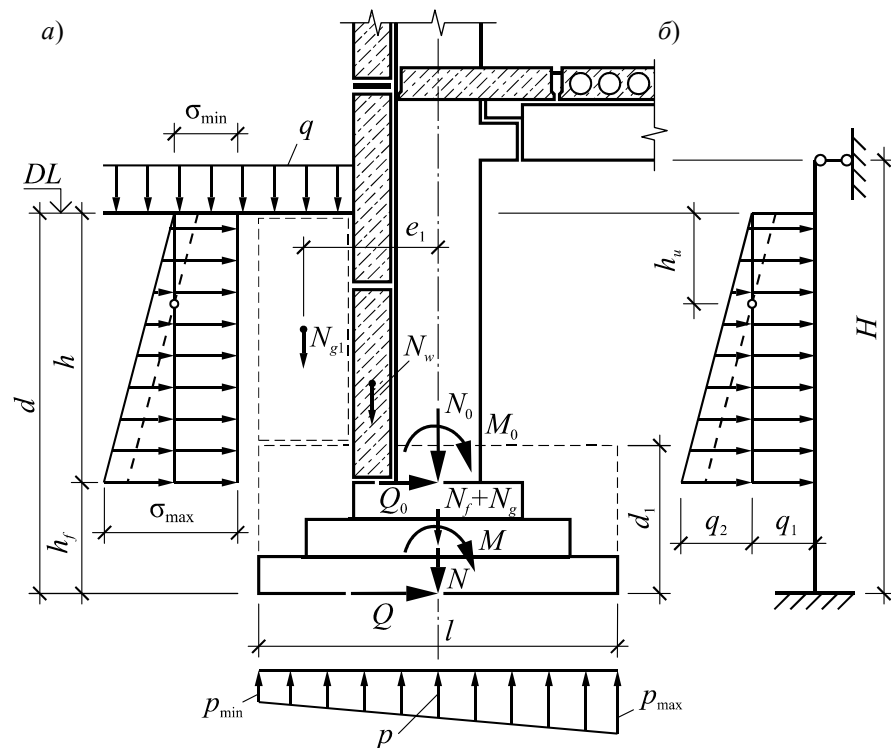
Расчетные схемы к сбору нагрузок на основание отдельного фундамента для здания с подвалом
